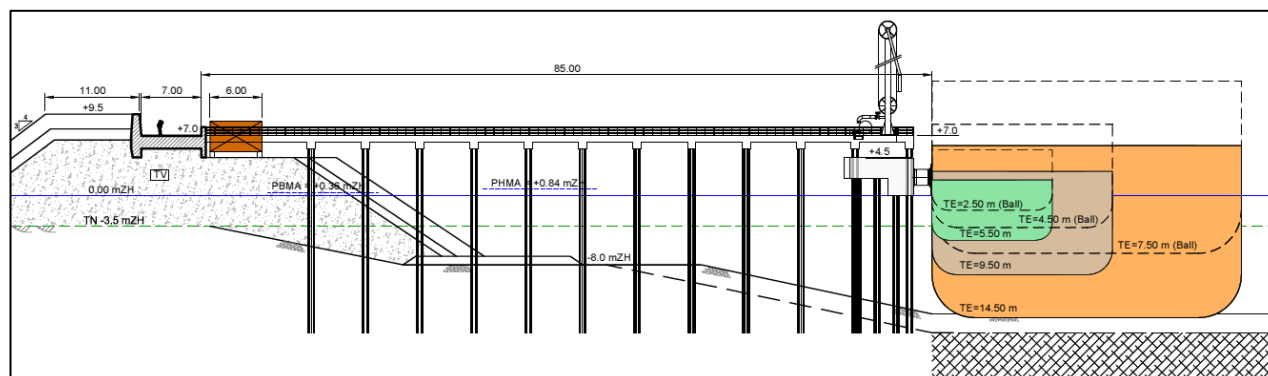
Plans et coupe du poste P1 « vrac liquide »
